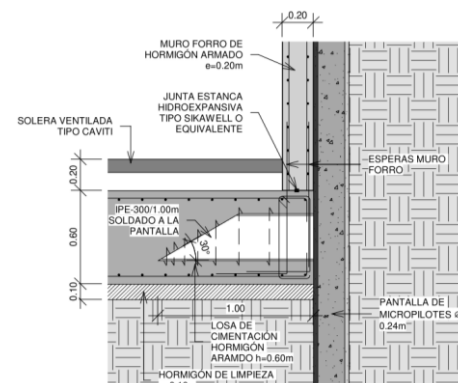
Detalle de pantalla de micropilotes y muro forro en arranque de cimentaciones
